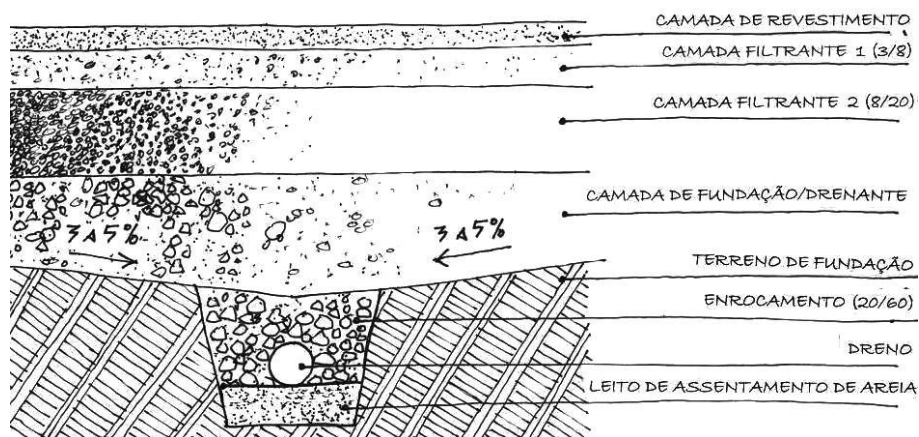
Pormenor esquemático do pavimento - Instalações ao ar livre
